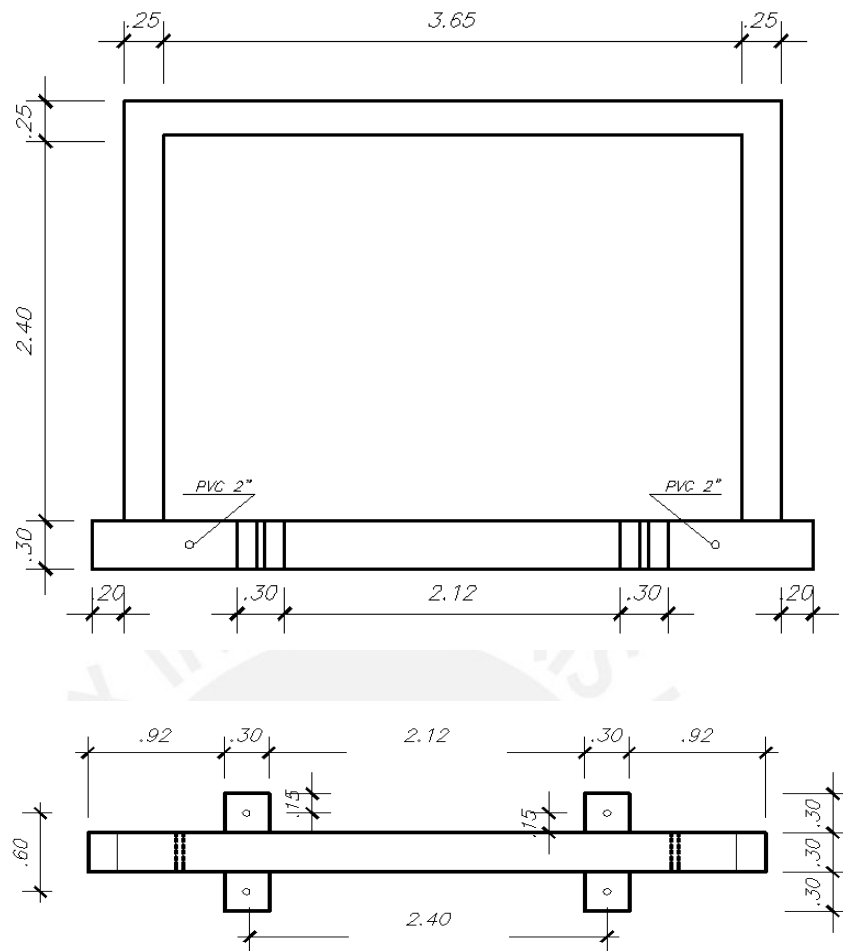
Dimensiones del Pórtico de concreto armado, Elevación y Planta.
